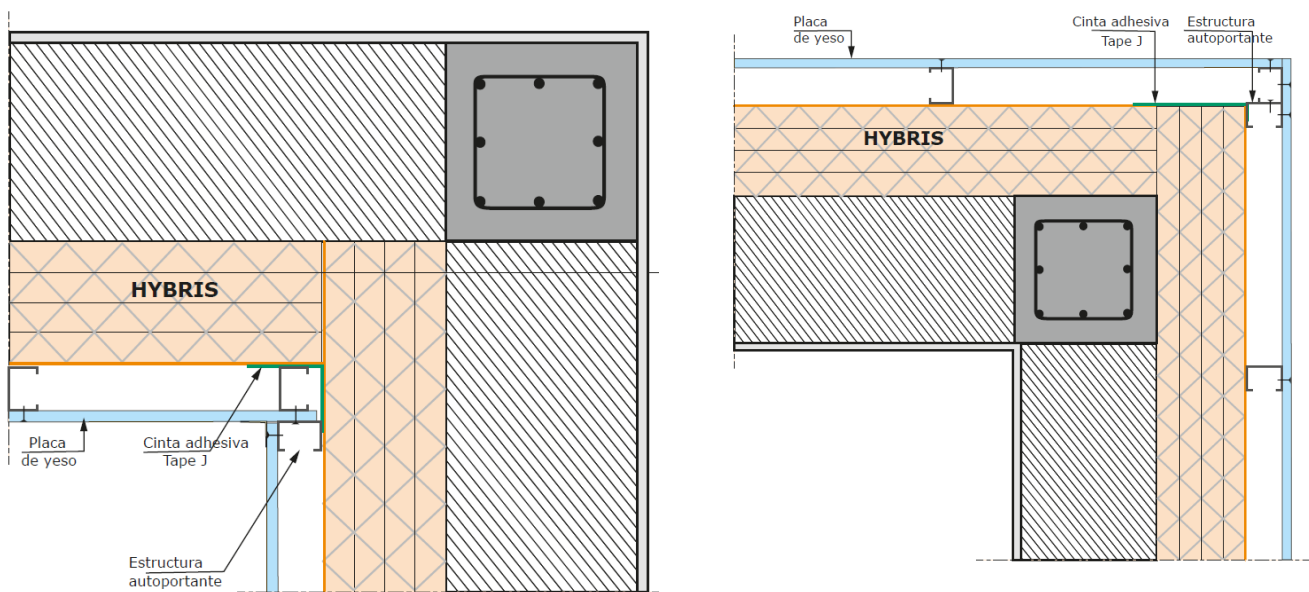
Tratamiento esquinas y rincones para la colocación del aislamiento HYBRIS.
